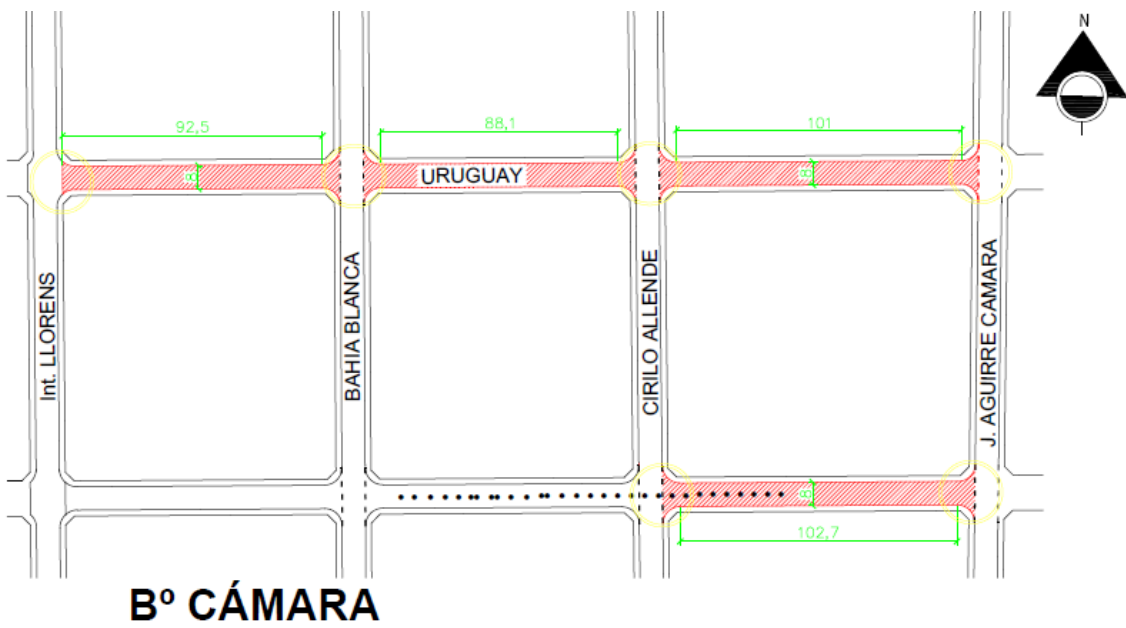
Calles a pavimentar en barrio Cámara.
